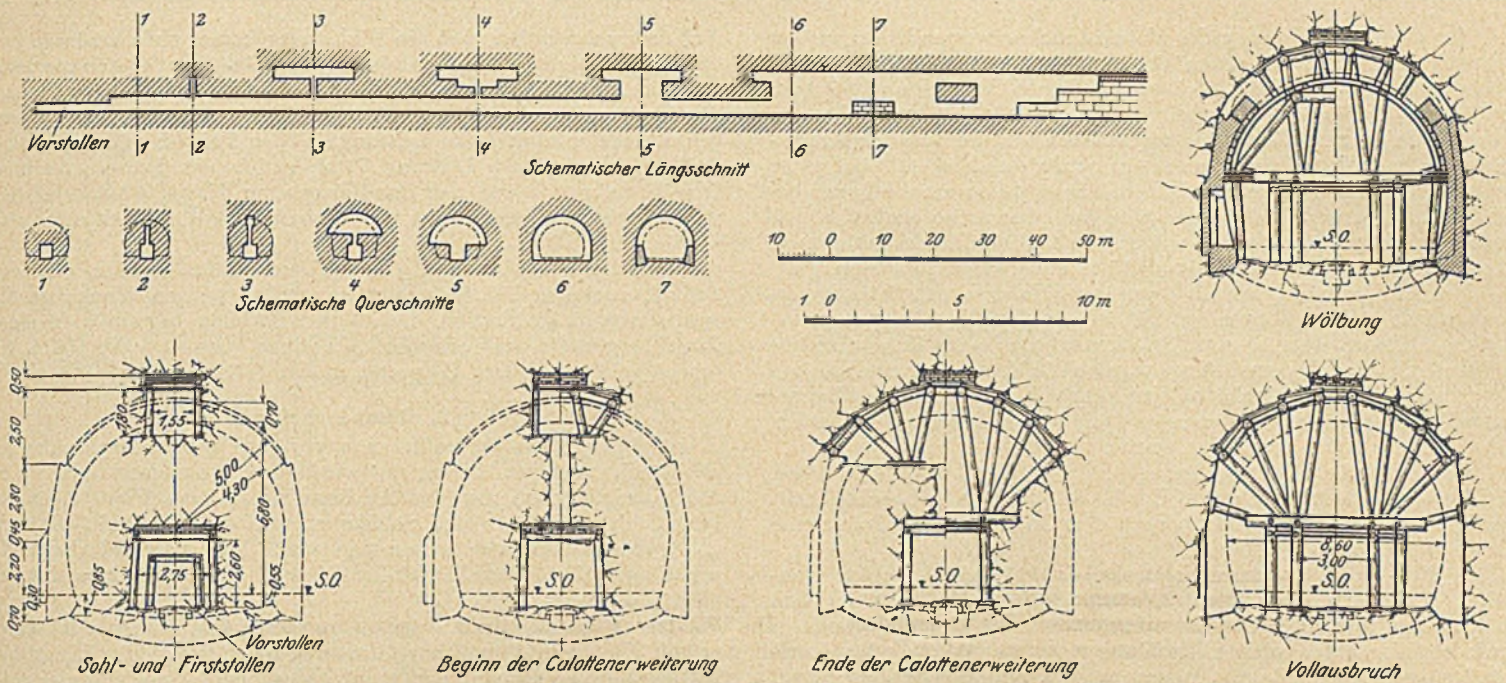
Der Bauvorgang mit Vor- und Hauptstollen, Firststollen und Vollaussbruch.
